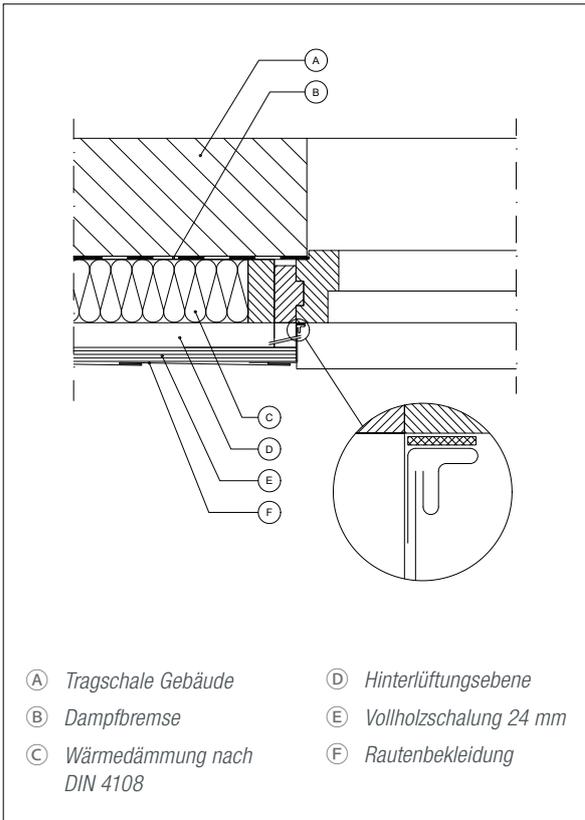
Rautensystem Fassadenanschluss
